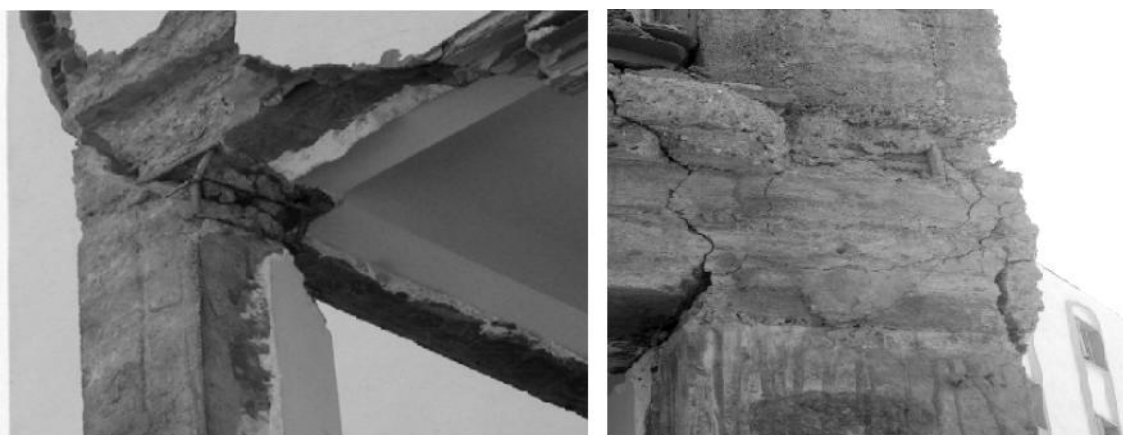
Fissuration des nœuds suite à l'absence du ferrailage transversal dans les nœuds
